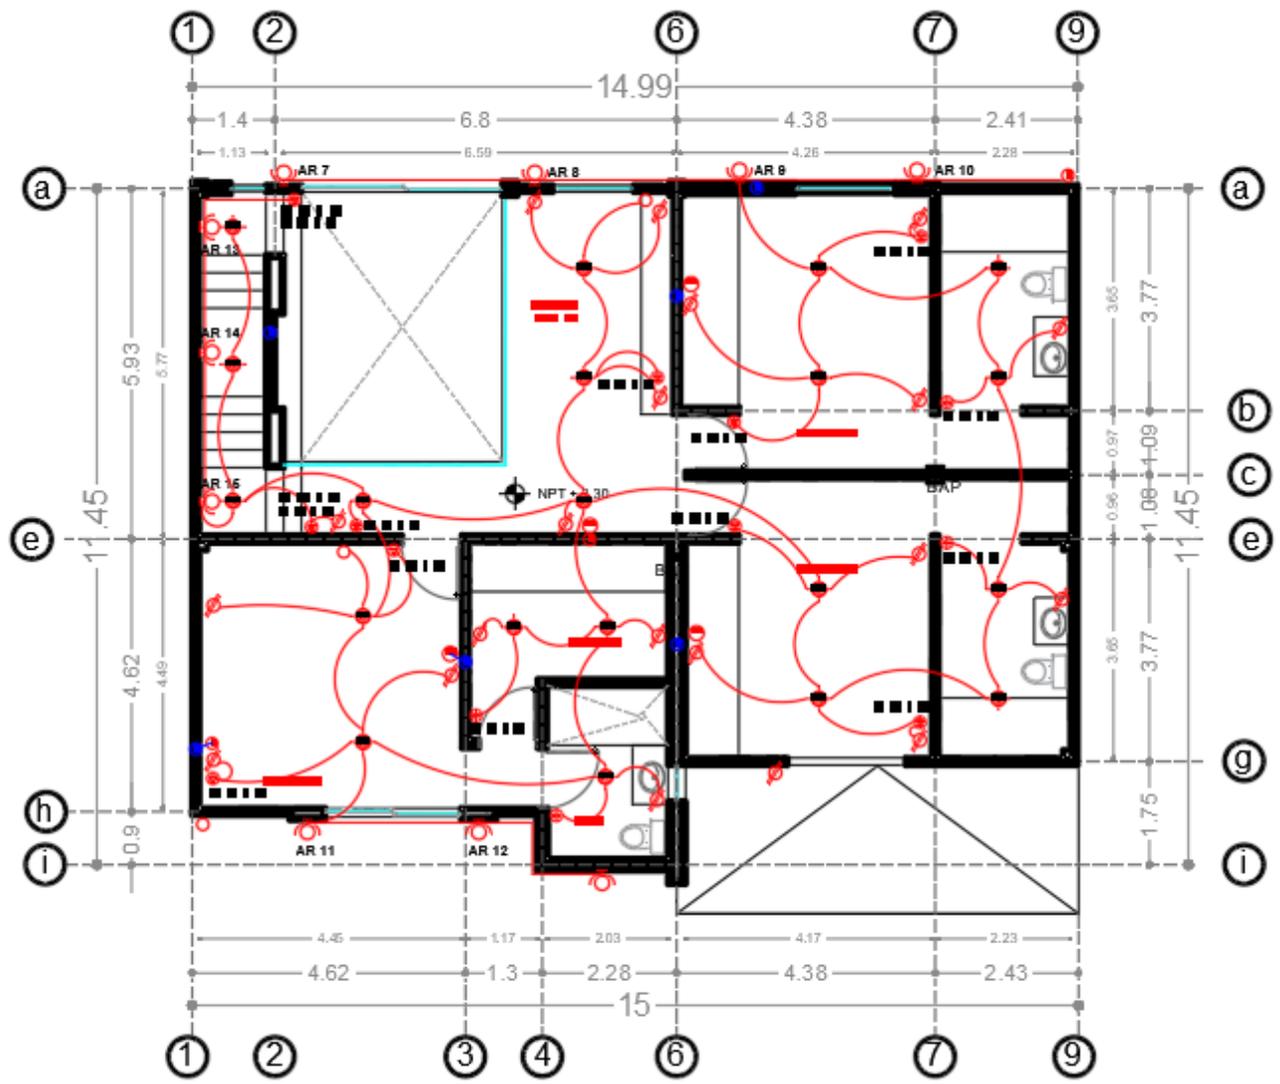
Plano eléctrico planta alta (Muciño, 2022)
